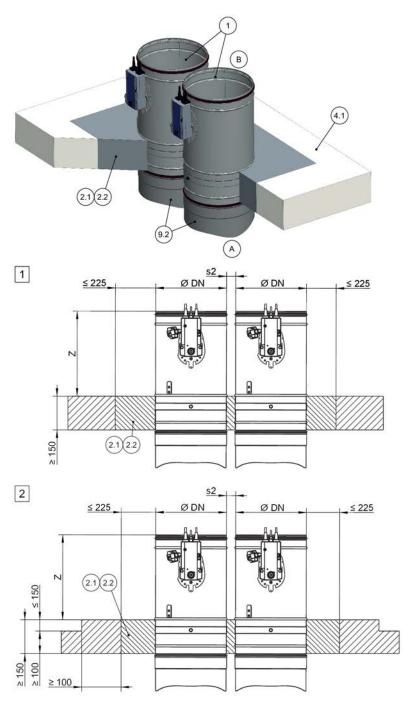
Montagem em argamassa numa laje de teto maciça com betonilha e isolamento acústico de passos, suspensa ou em pé
